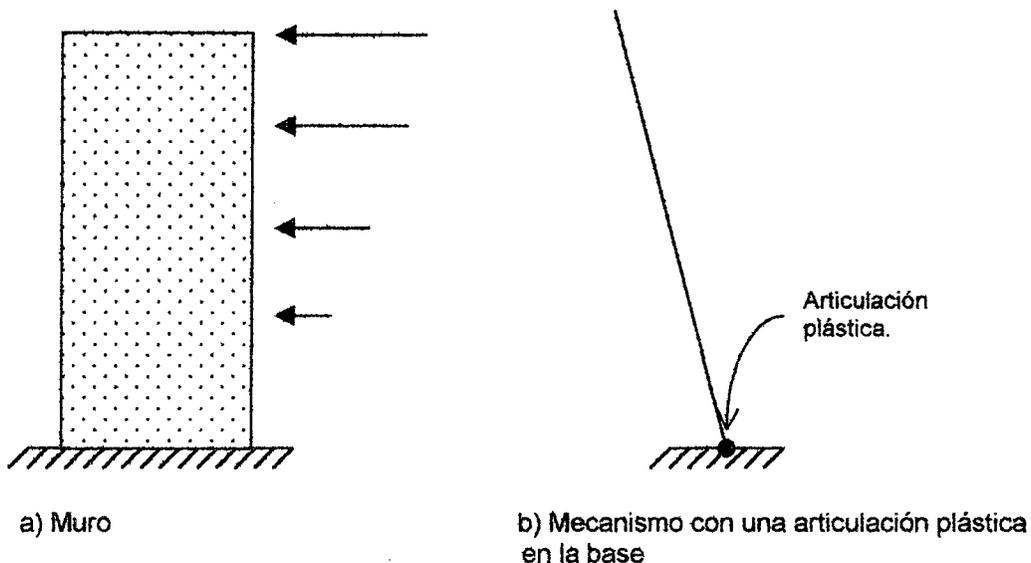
Mecanismo de falla de un muro de rigidez aislado sujeto a cargas laterales
